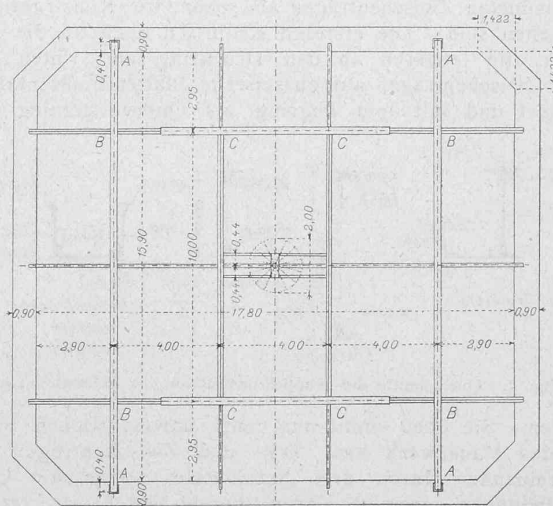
Grundriss des Bodens unter der Kuppel. — Masstab 1:250.
